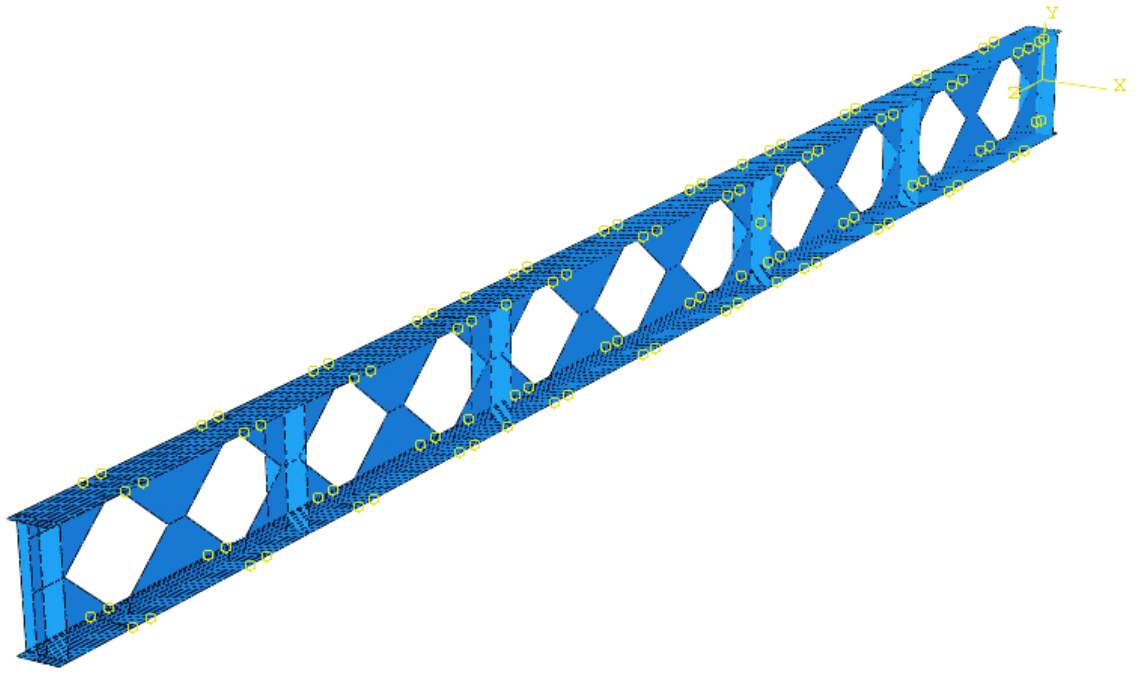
Geometria das vigas ensaiadas por Toprac e Cooke (1959).
